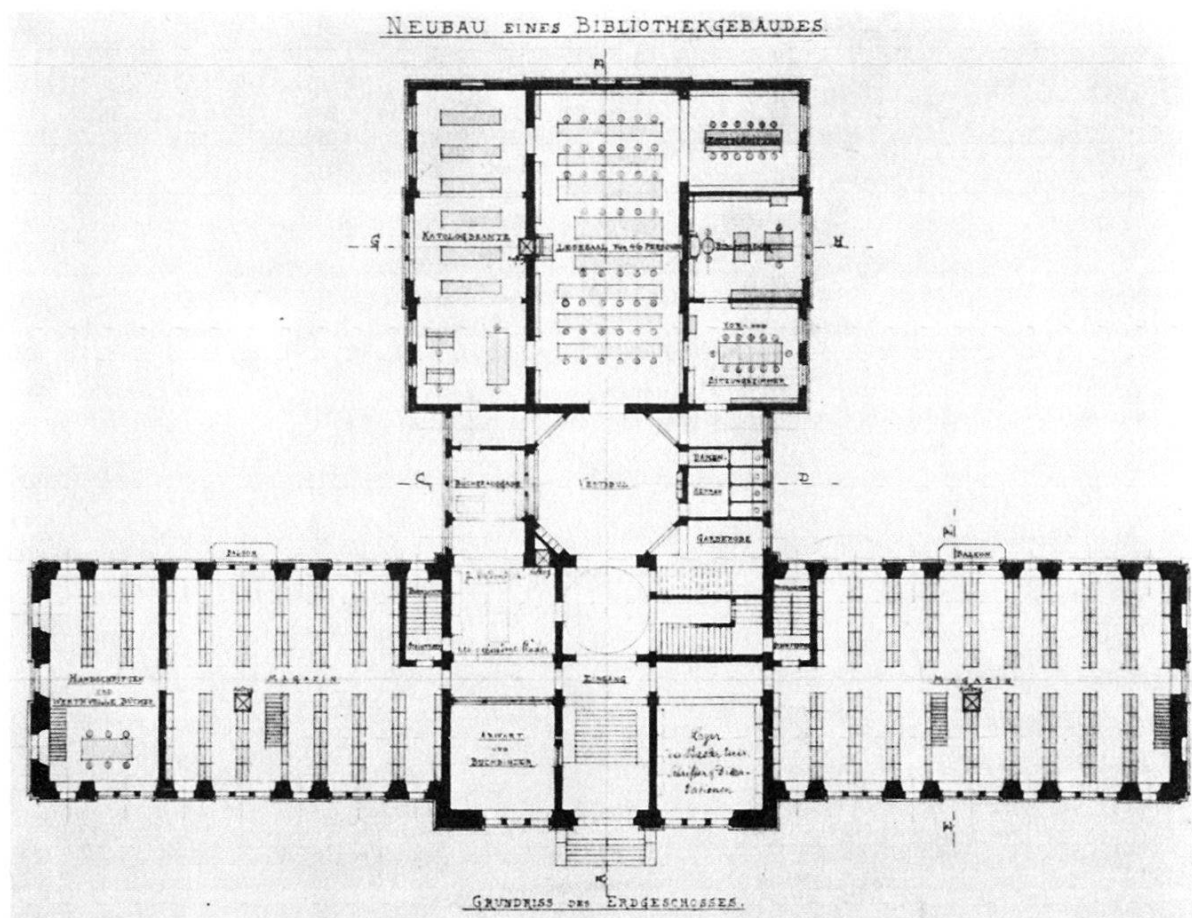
Bibliotheksprojekt von Reese, Grundriss des Erdgeschosses.
